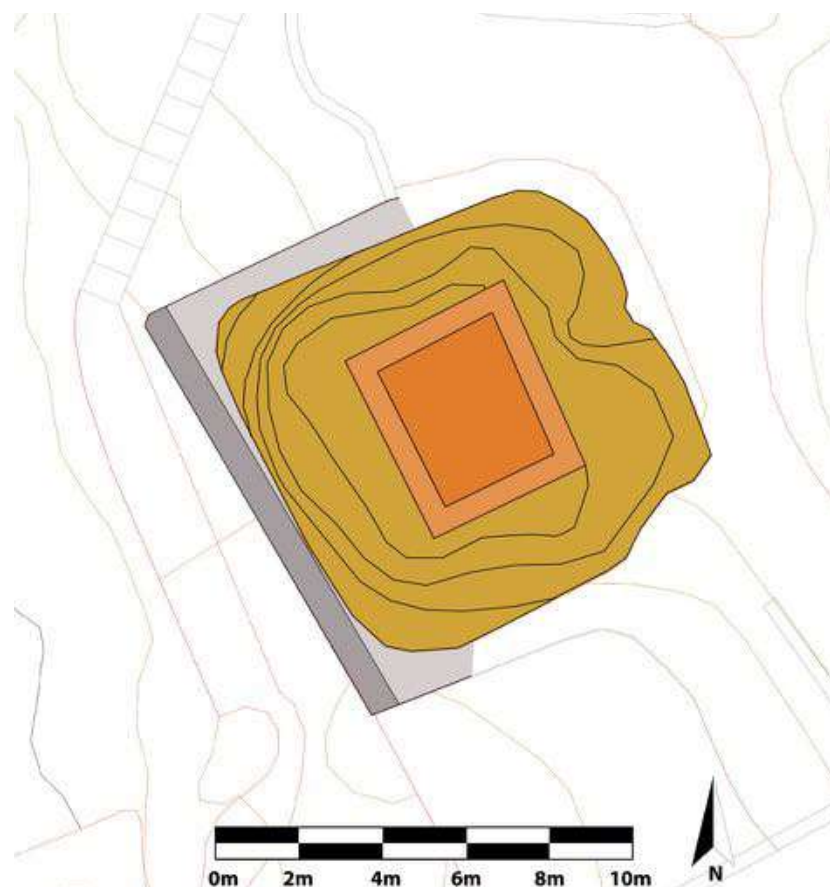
Topografía de la torre de la Tahona. En gris claro, la zapata de mampostería. En marrón claro la obra de tapial y en el centro el espacio del aljibe. En gris oscuro, el recubrimiento de mampostería con verdugadas de ladrillo. Fuente: elaboración propia sobre topografía del PGOU de Comares.
